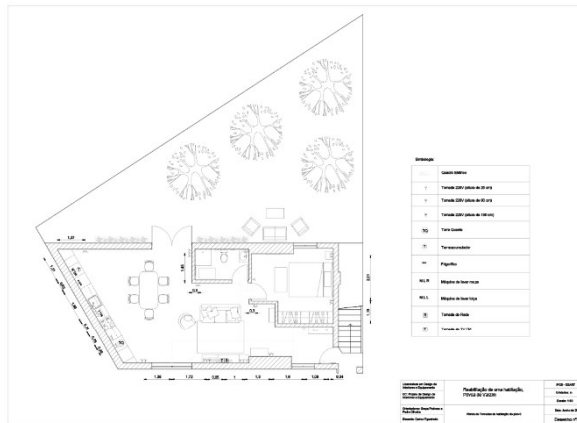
Planta de Tomadas Habitação Piso 0. Fonte: Autor.
